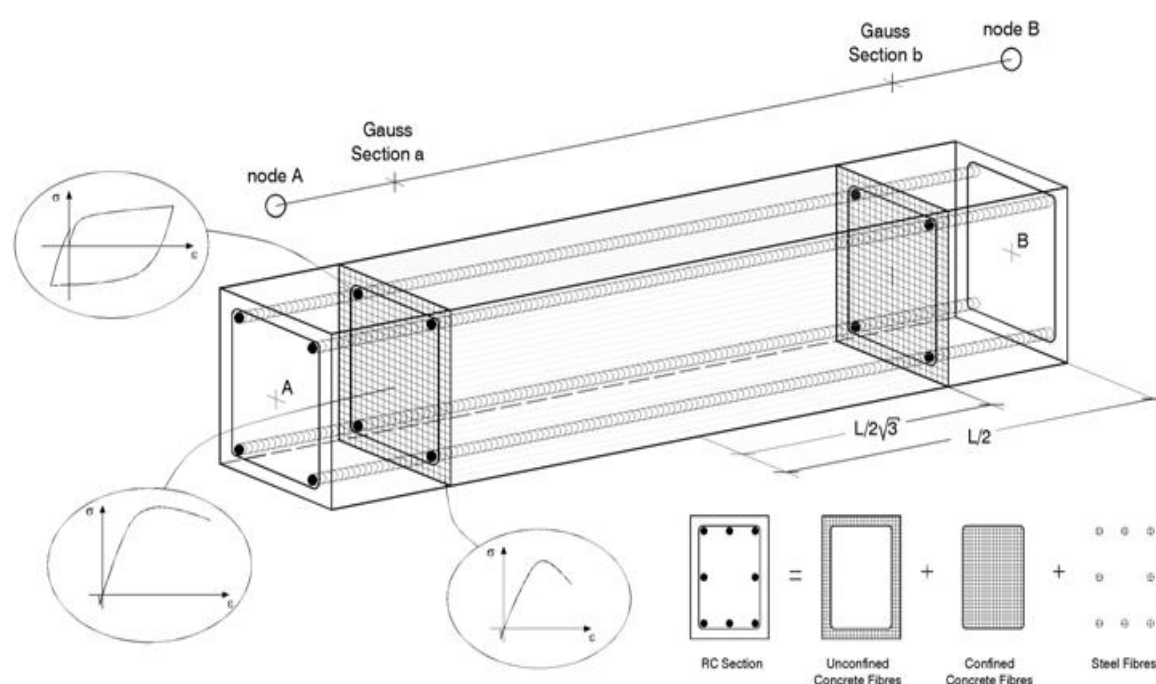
Discretização longitudinal e de uma secção transversal de um elemento de betão armado. (*SeismoStruct*, 2012).
